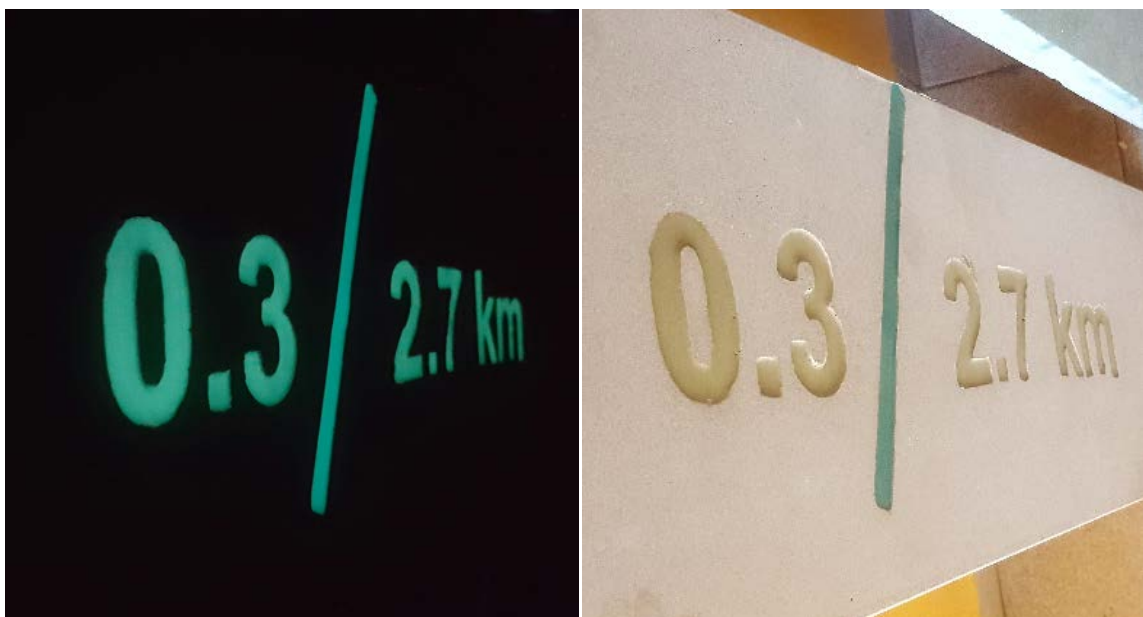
Señalética UFL, integrada en bloques prefabricados de hormigón.
